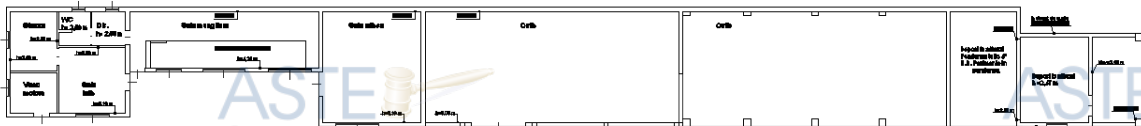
Planimetria stato di fatto con indicazione della sagoma dell'immobile.
